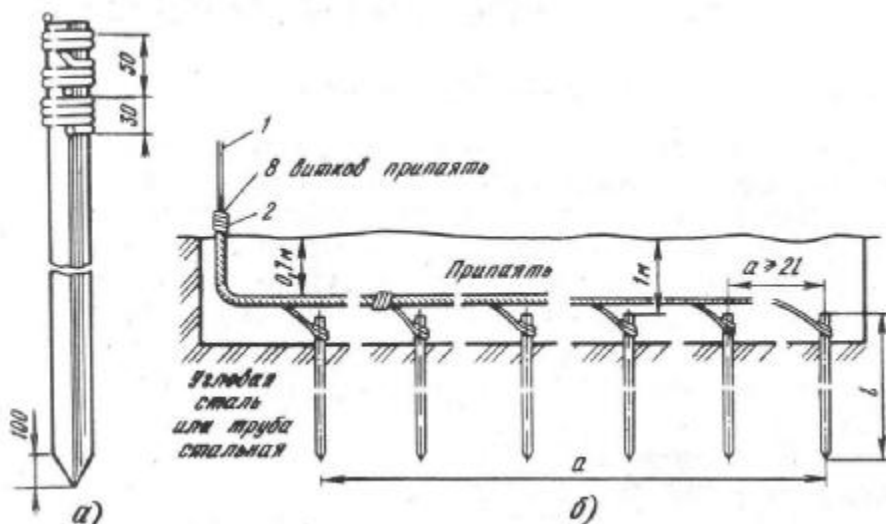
Устройство трубчатых заземлений: а — одиночного; б — многоэлектродного: 1 — проволока стальная диаметром 4... 5мм; 2 — проволока перевязочная диаметром 2мм.
